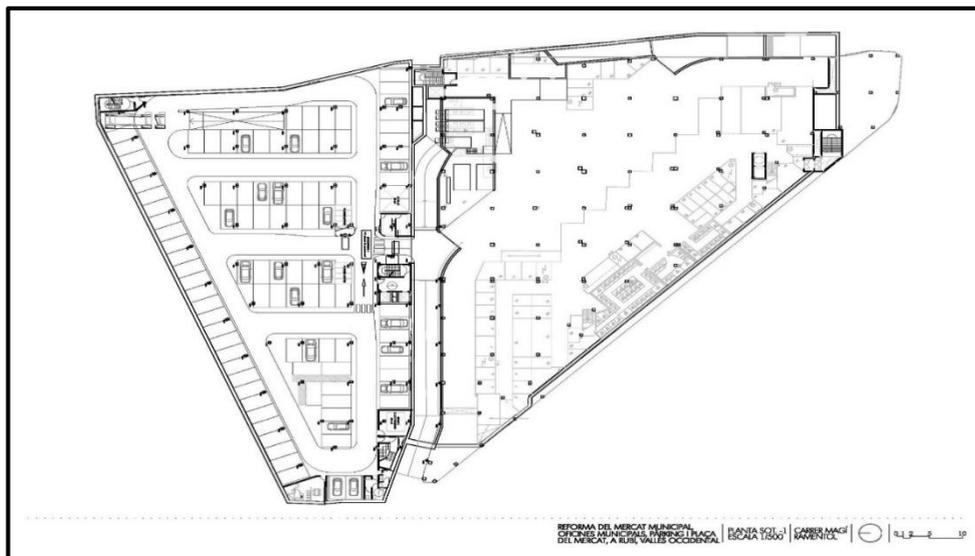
Plano en planta del diseño del aparcamiento subterráneo
